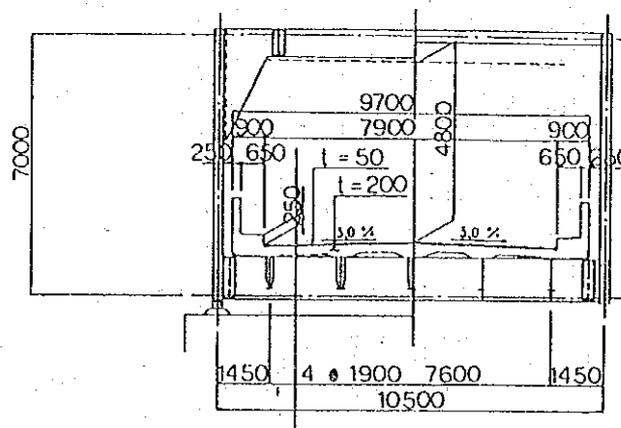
Sección Transversal de la Superestructura (Vigas de Celosía Tipo Warren)
